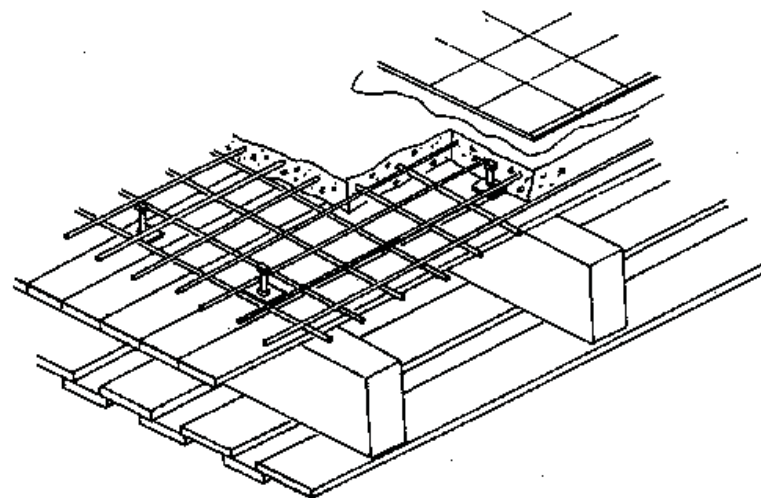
Laje mista madeira /betão com ligadores metálicos.
